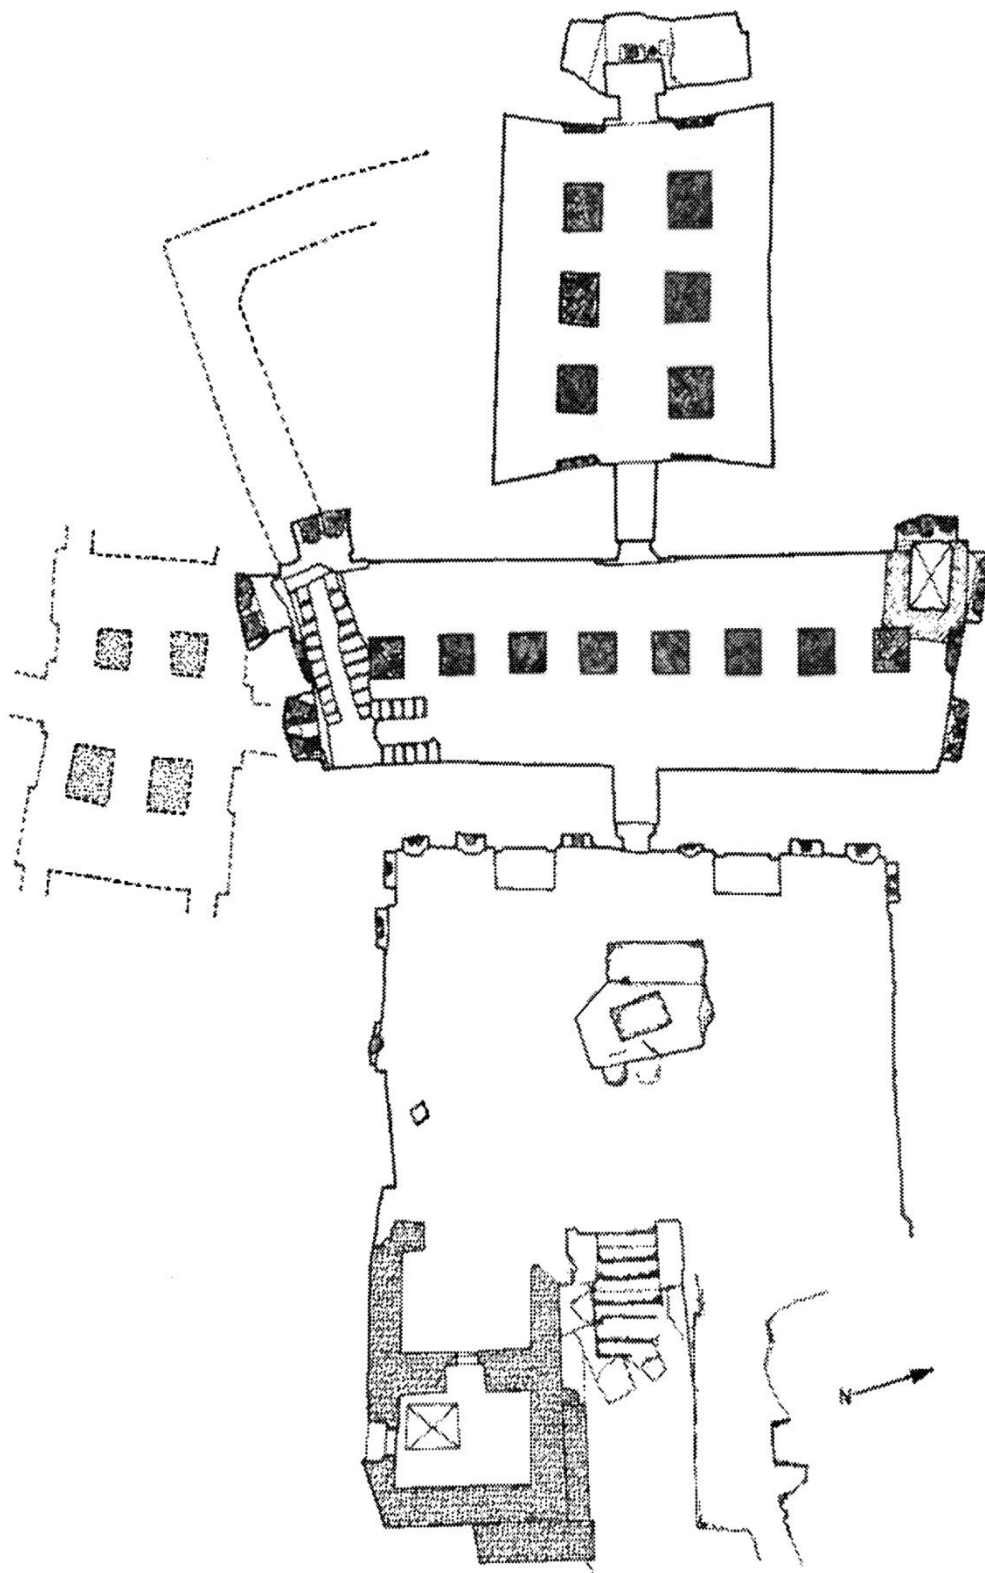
Plano TT 106 (Seyfried, 1990)
